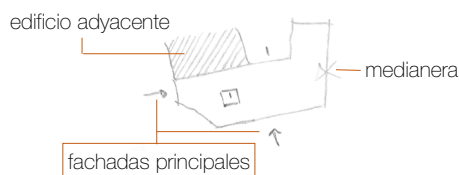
Boceto en planta del edificio ubicado en Rúa Manuel de Castro, 11 (autoría propia).
